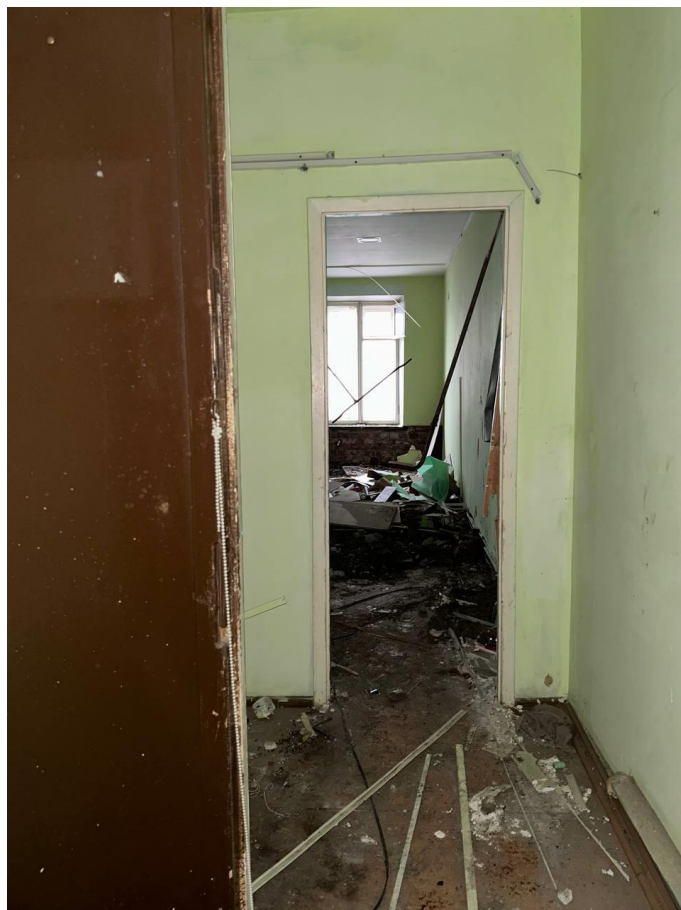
Тамбур на 1-м этаже, вид с лестничной клетки.
